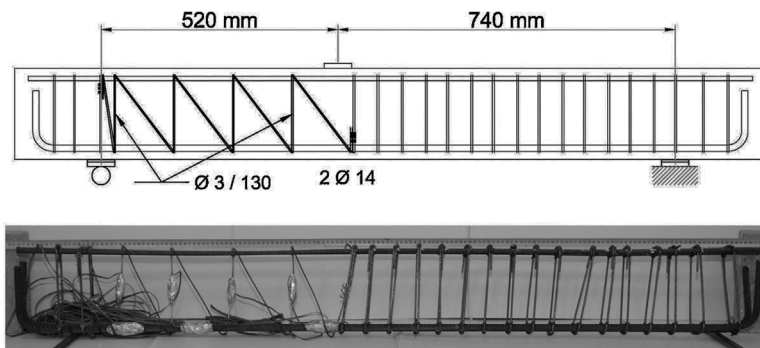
Geometría de las vigas y diferente tipo de armado utilizado para las vigas reforzadas con cercos convencionales de acero y con helicoides Ni-Ti.
